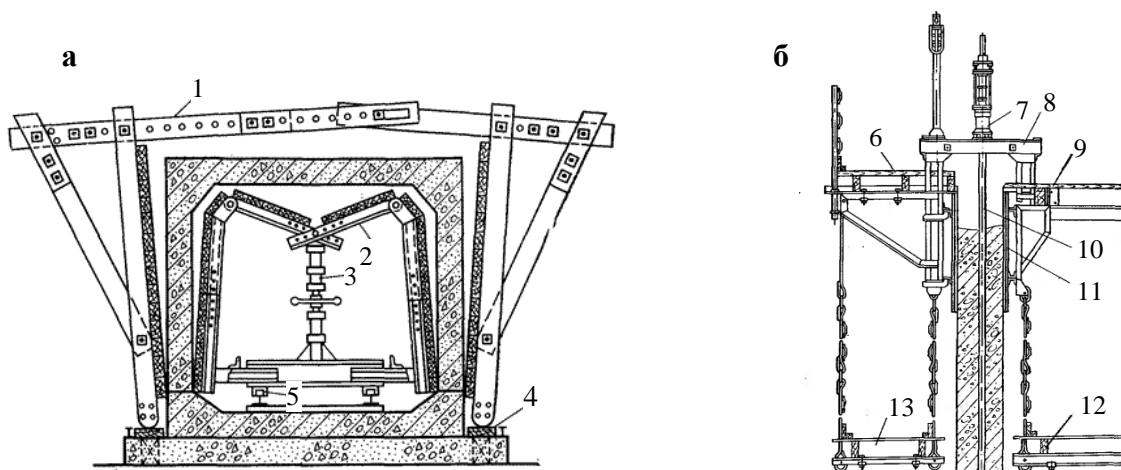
Схеми опалубки: а – катучої для бетонування прохідних каналів; б – уніфікованої ковзної; 1 – рама зовнішньої опалубки; 2 – металева рама внутрішнього палублення; 3 – механізм для розпалублення та приведення опалубки в транспортне положення; 4 – опорна дошка; 5 – каток; 6 – козирок; 7 – домкрат; 8 – домкратна рама; 9 – робоча підлога; 10 – домкратний стрижень; 11 – щити опалубки; 12, 13 – внутрішні й зовнішні починні підмостки
